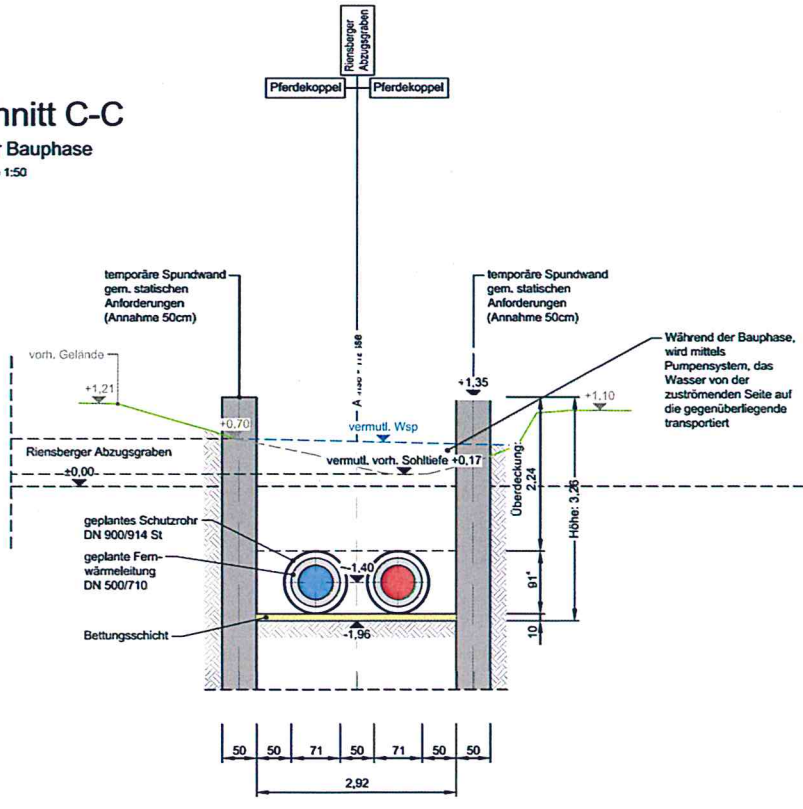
b Schnitte Auszug aus dem Plan Nr. 4.12.5.2
